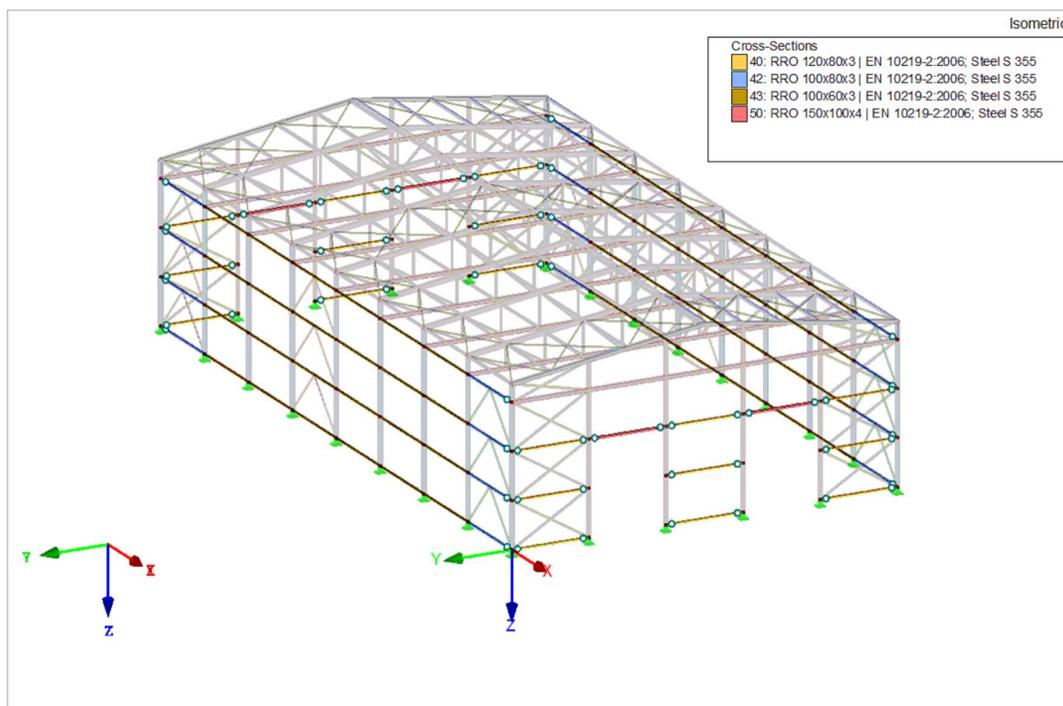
Plan pozicije sekundarne krovne konstrukcije
